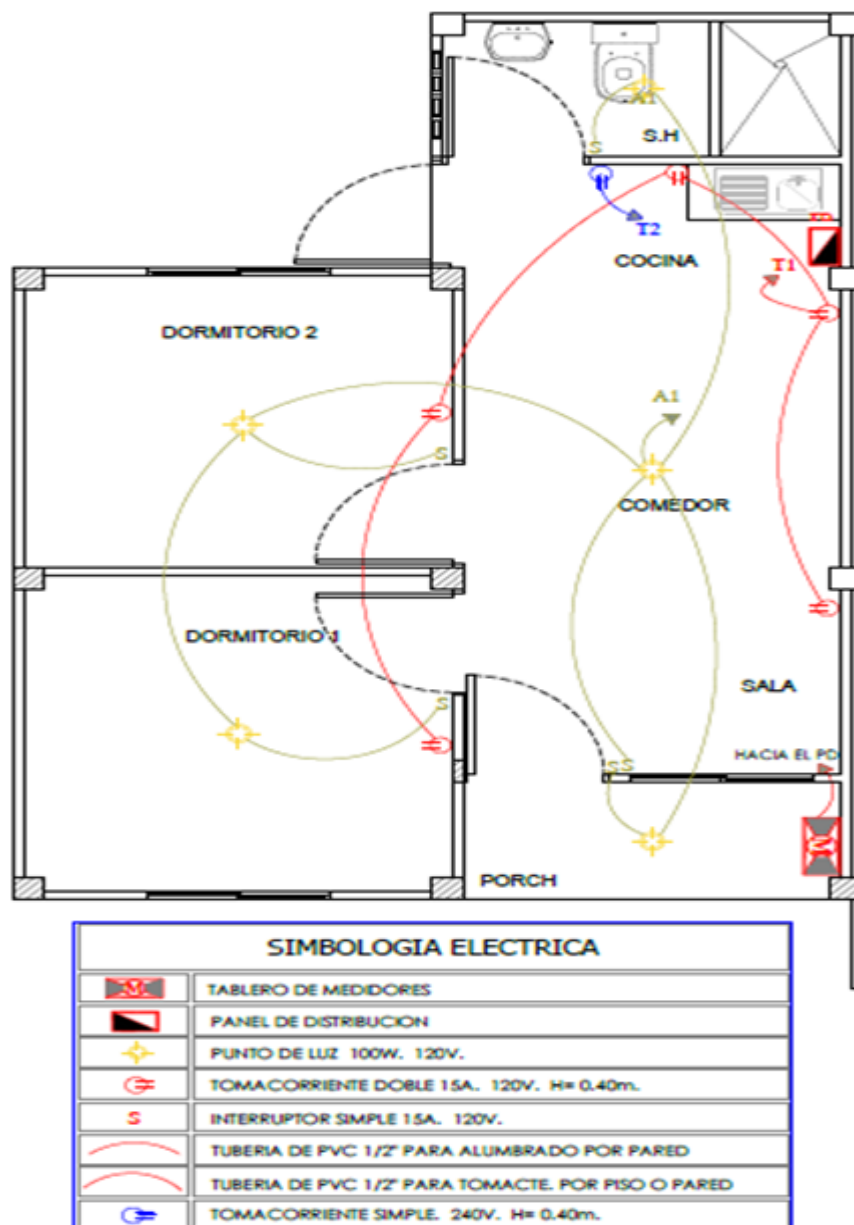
Plano Eléctrico de la Vivienda Modelo.
